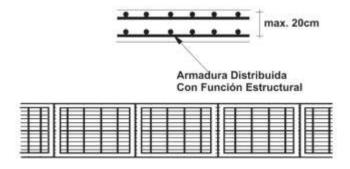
PCH con refuerzo de Acero Estructural Fuente: Acurio, 2012
